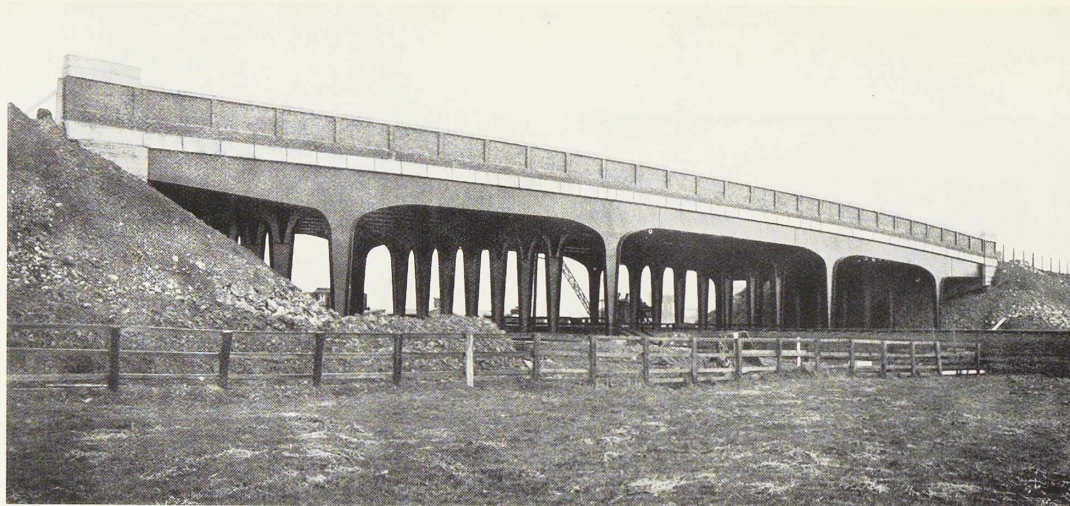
Pont soudé à 5 travées à poutres à âme pleine, à béquilles, situé dans la rampe d'accès côté Nord du pont levant.
